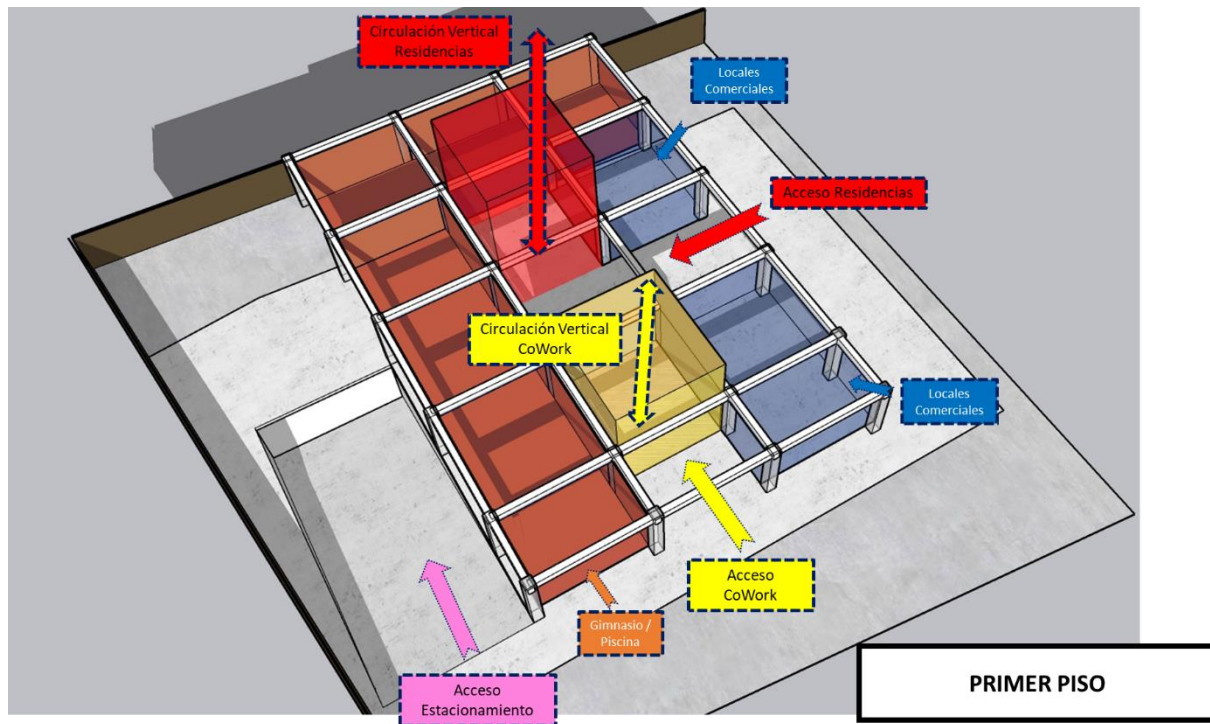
Layout Primer piso Proyecto. Ver detalles en Anexo n°19
